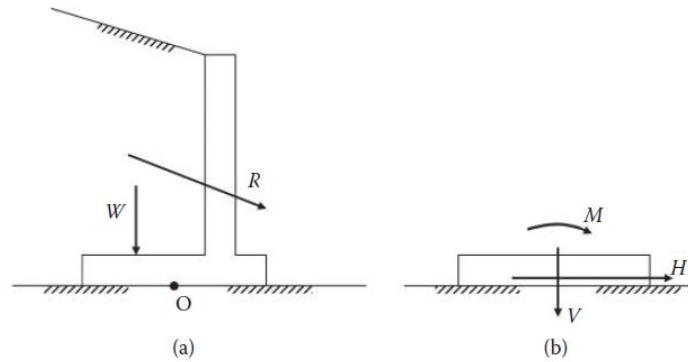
Charges combinées verticale, horizontale et moment sur une fondation superficielle : (a) forces sur un mur de soutènement gravitaire ; (b) représentation schématique des charges sur la fondation. (Butterfield 1993).
